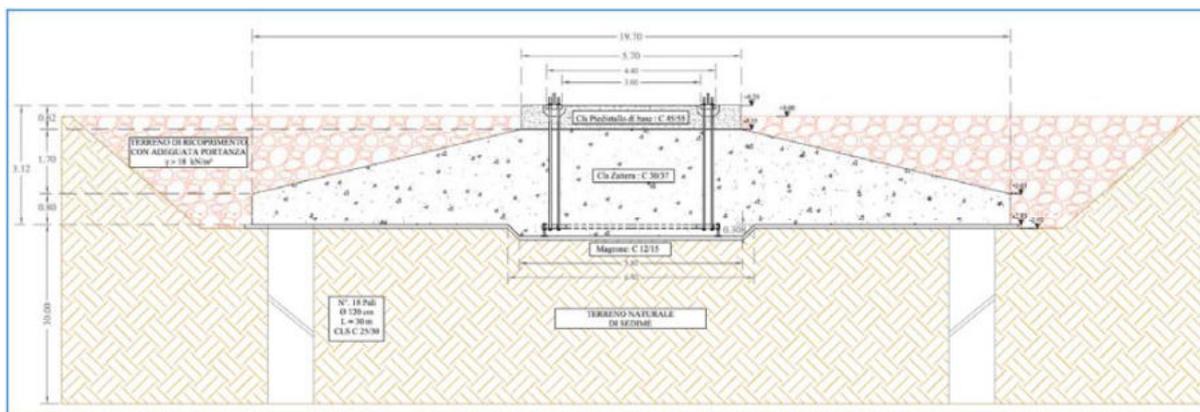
Sezione tipo fondazione aerogeneratore.
